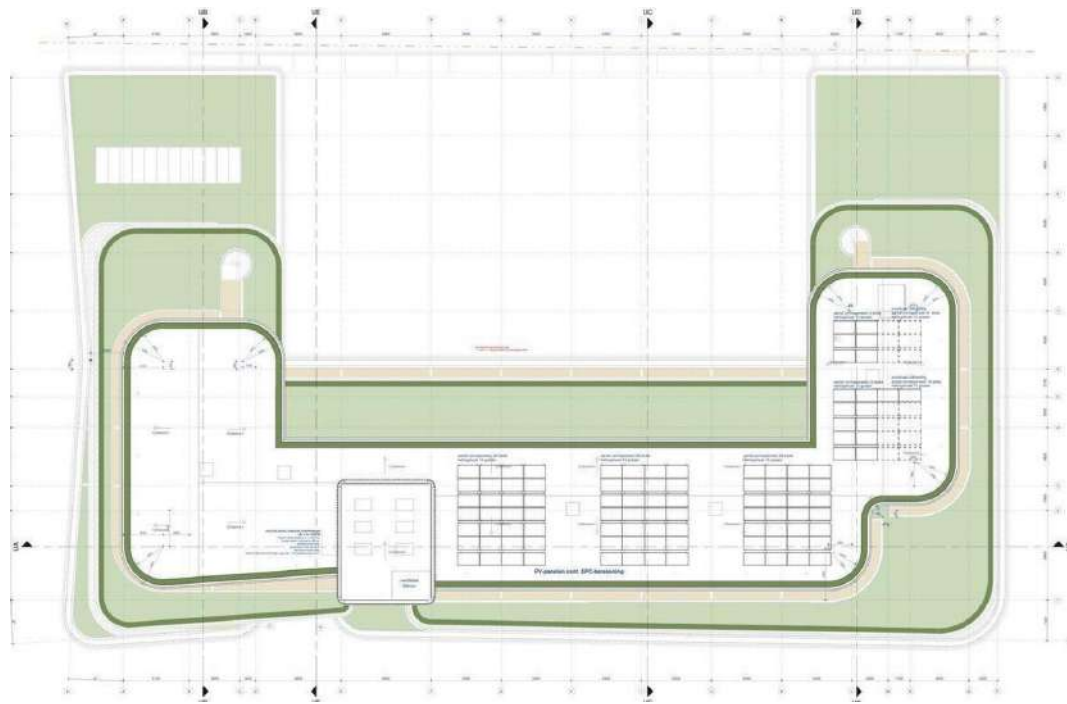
План будівлі Duinhotel Breezand [2]
